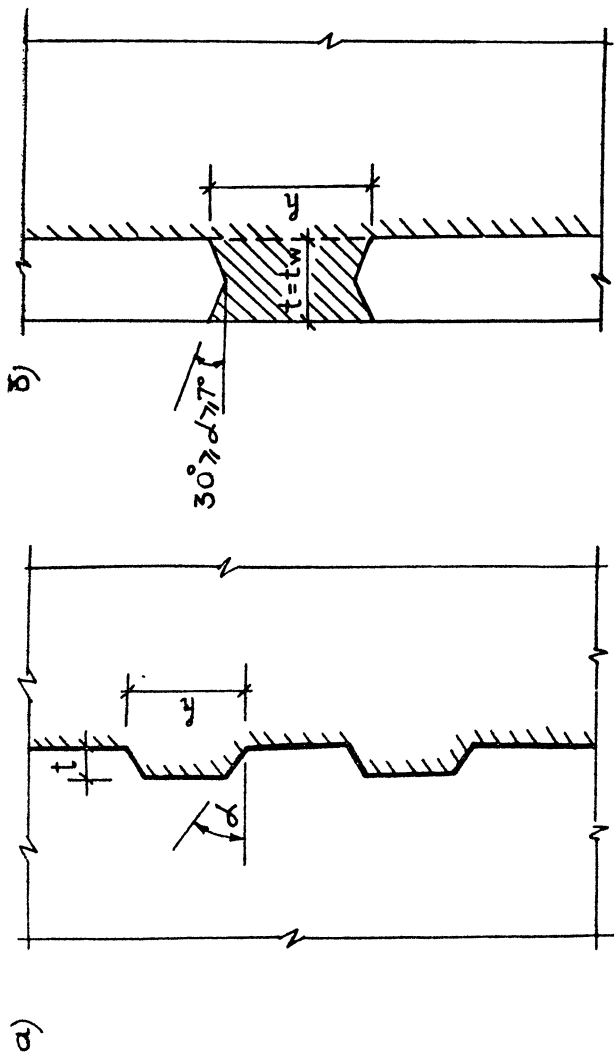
Схема шпоночных поверхностей в контактных вертикальных стыковых соединениях монолитных стен:
